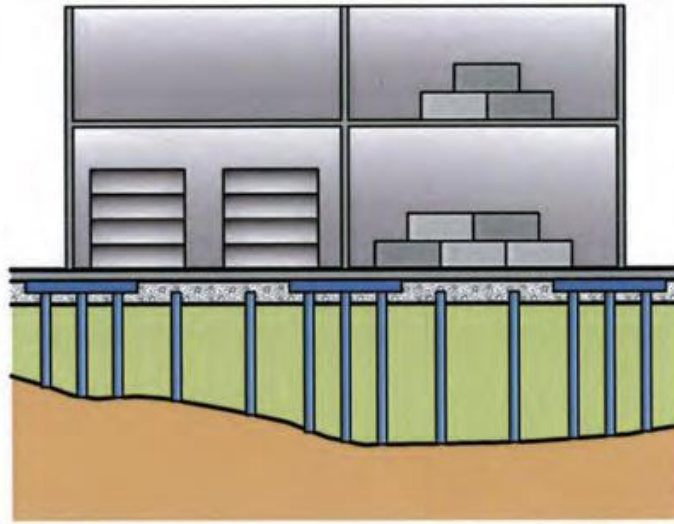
Dallages et fondations de bâtiments industriels. [6]
